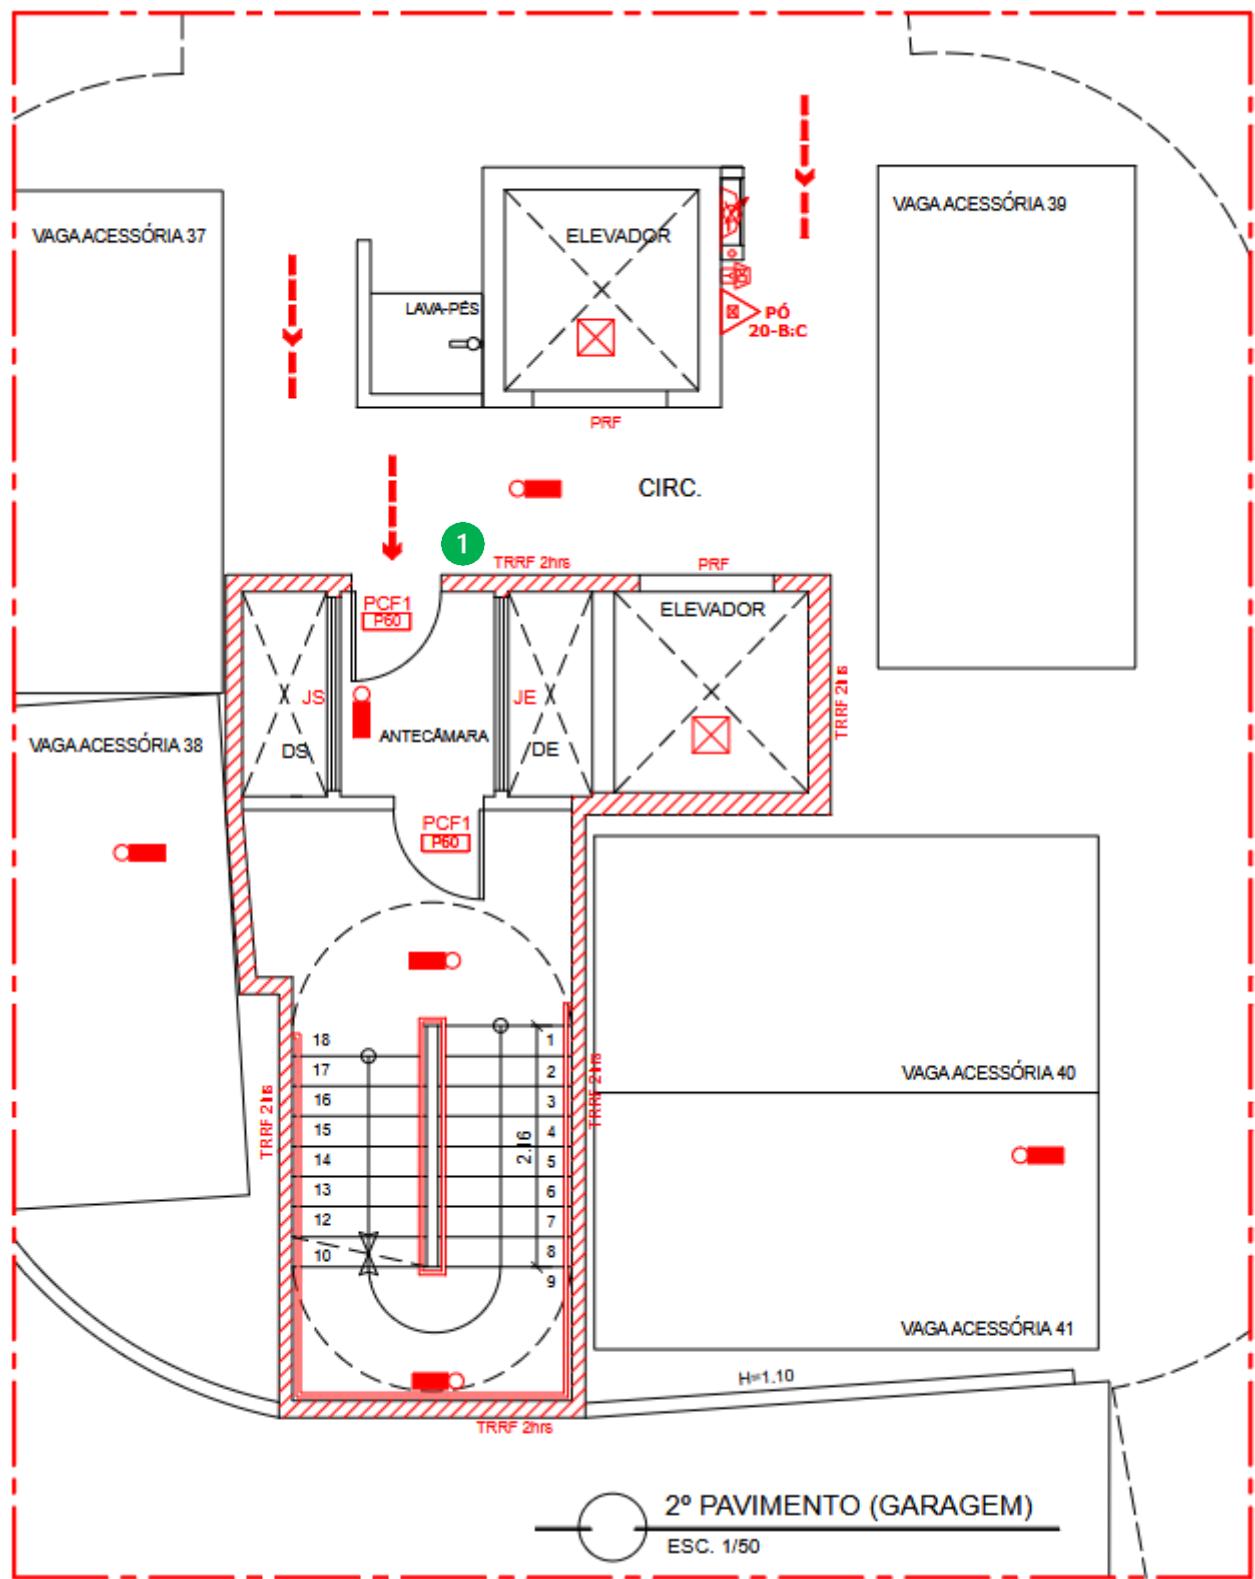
Trata-se de planta baixa parcial de pavimento garagem superior. As setas vermelhas sinalizam o sentido de fuga, a saber da garagem para a caixa de escada. O elemento verde (1) indica a localização definida para os dispositivos (manual / eletrônico) das portas de saída de emergência.
